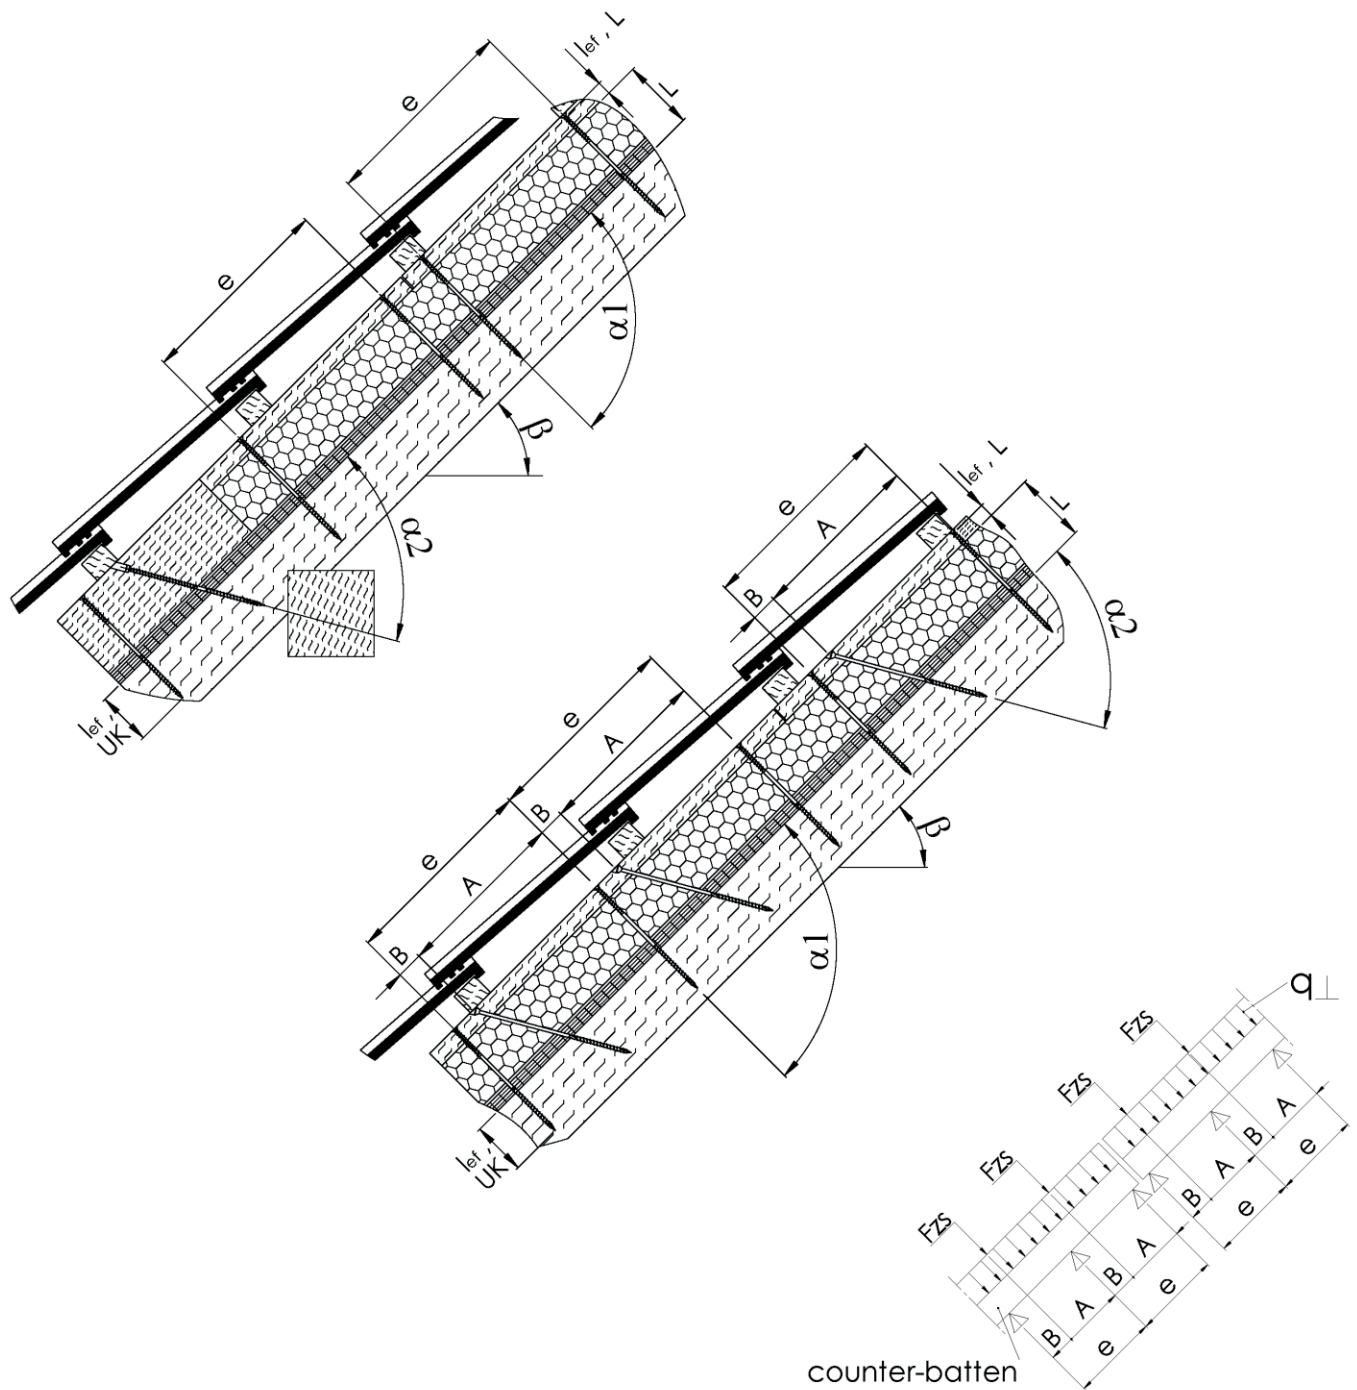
Mise en œuvre d'un isolant thermique sur des chevrons - système structural pour des vis inclinées alternativement et une poutre continu sous charges linéaires constantes provenant des actions exercées sur le plan de la toiture  $q_{\perp}$  et des charges concentrées provenant des vis en traction  $F_{ZS}$
